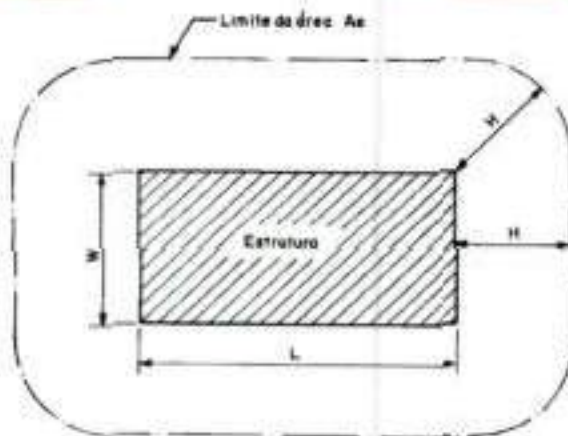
Delimitação da área de exposição equivalente (A_e) - Estrutura vista de planta
